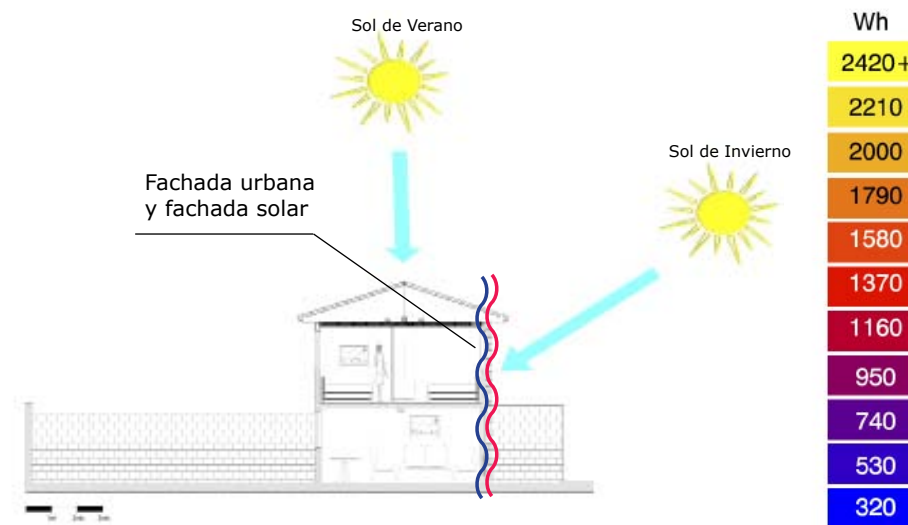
Fachada Solar y Fachada Urbana del bloque con Orientación NORTE.
